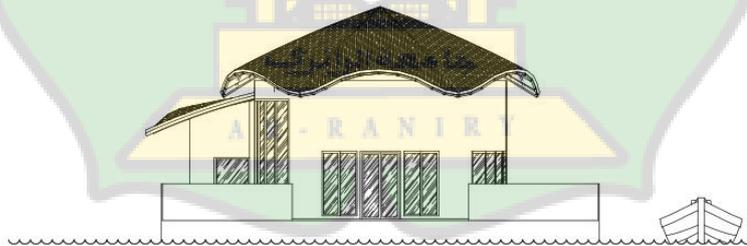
Tampak Samping Kiri Bangunan Lobby dan Pengelola
